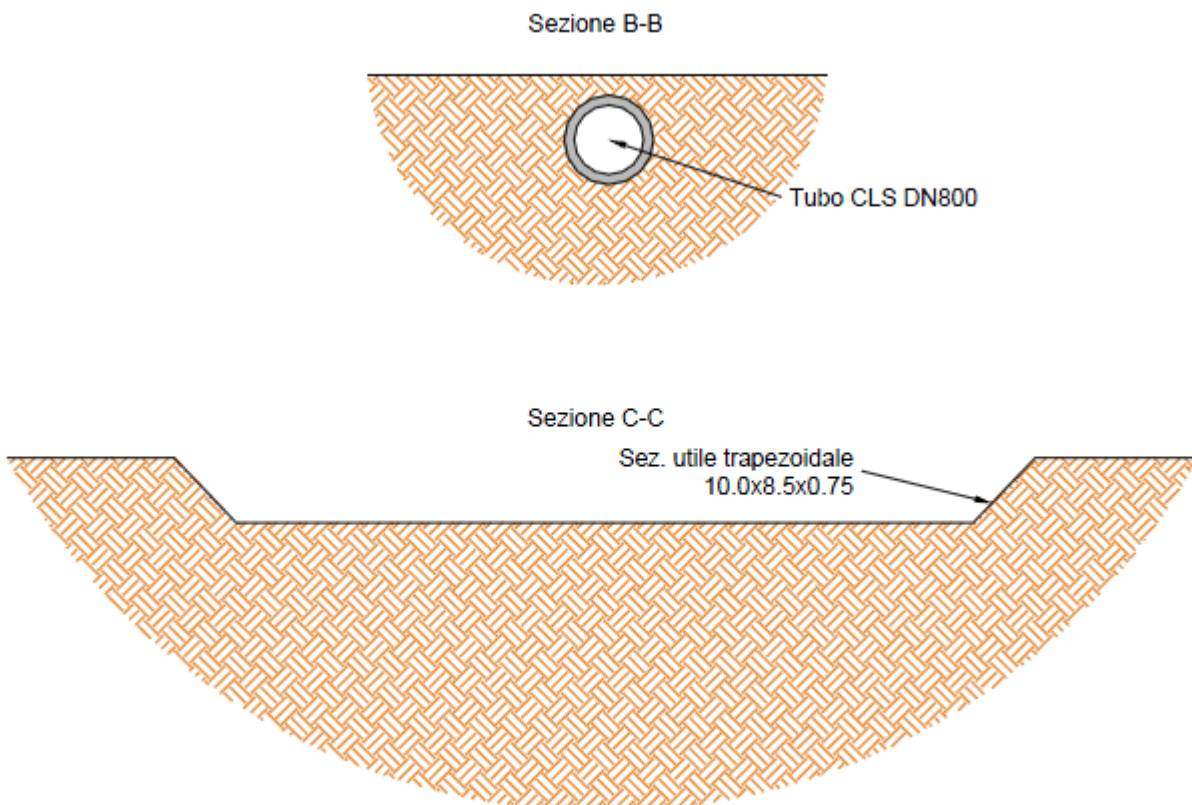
Sezioni trasversali fosso interpodereale allo stato di progetto (canale di laminazione) (Stralcio TAV 5).
